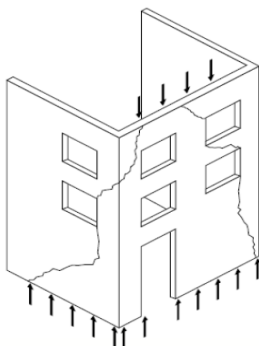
Tipologia da fissuração originada pela sobrecarga. [8]
